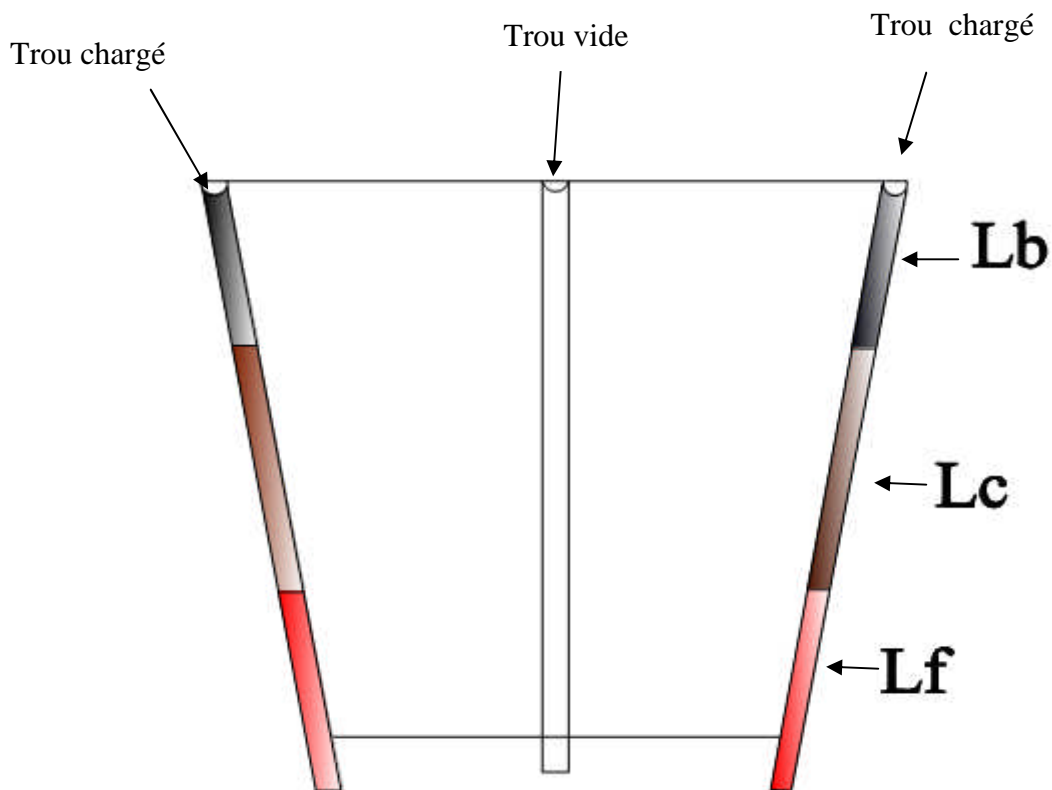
Coupe d'un plan de tir pour le stérile.
